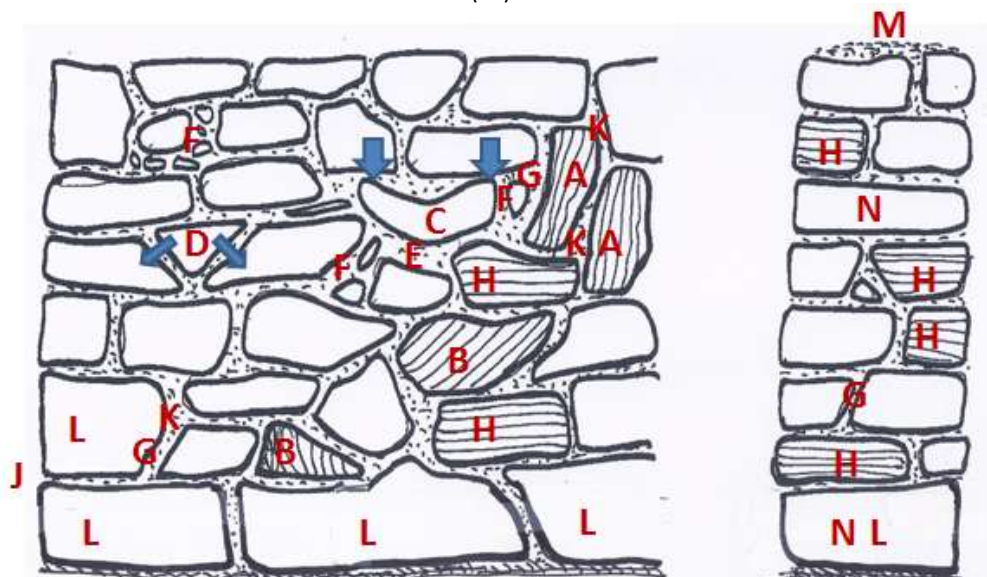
Mampostería detallando elementos. Fuente: elaboración propia
